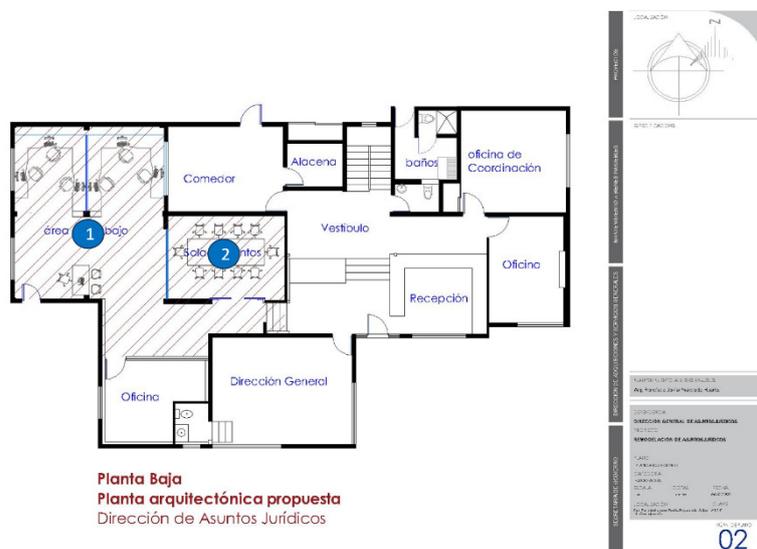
Planta baja remodelación para sala de juntas y área de trabajo junto con archivo de la dirección de asuntos jurídicos. Proyecto por parte de la Dirección General de la Administración.
